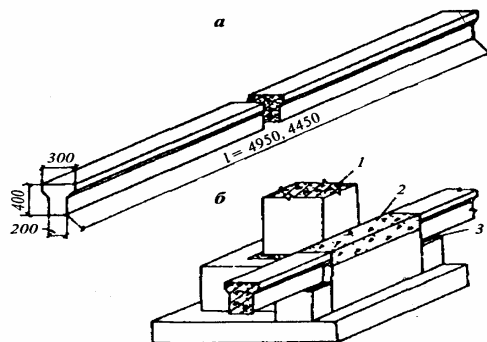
Железобетонные фундаменты и фундаментные балки:
